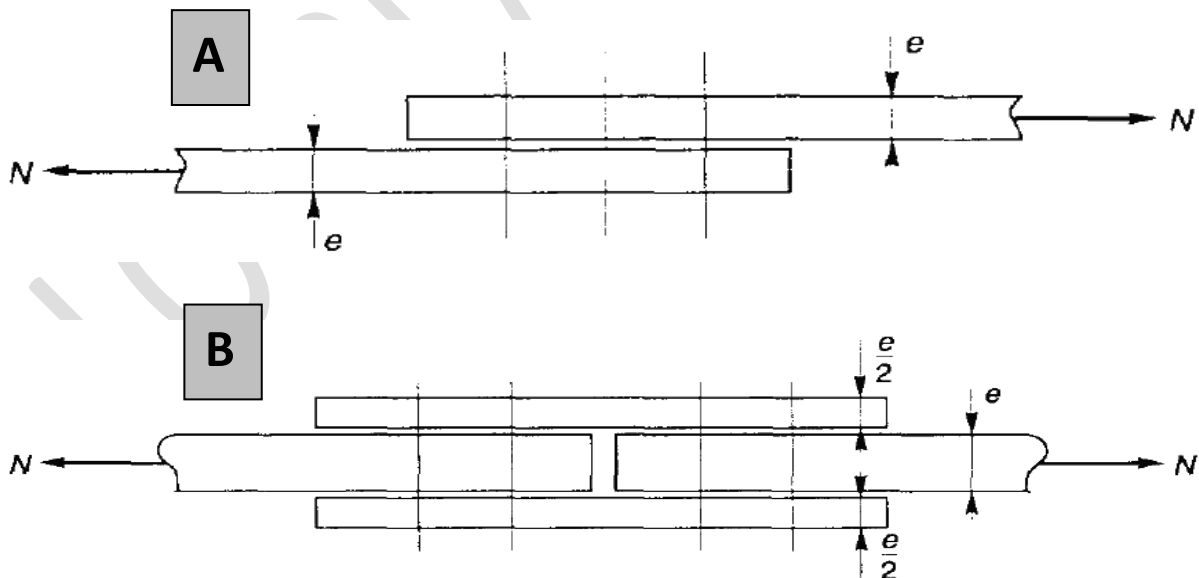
(A) Assemblage par recouvrement , (B) Assemblage symétrique par double couvre-joint.
